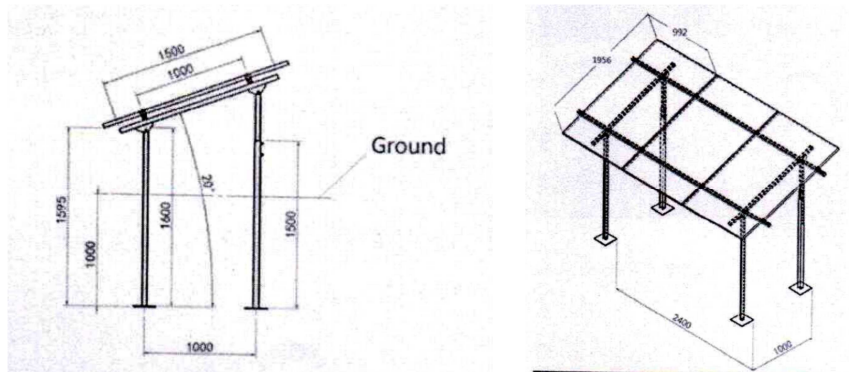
Dimensiones de las Estructuras de Apoyo
